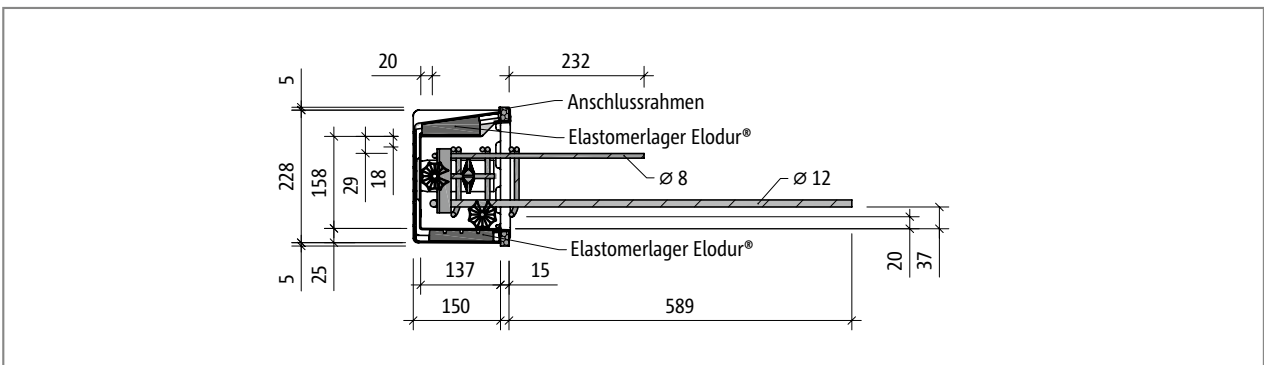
Schöck Tronsole® Typ Z-V+V-T beziehungsweise Typ Z-VH+VH-T: Vertikalschnitt
